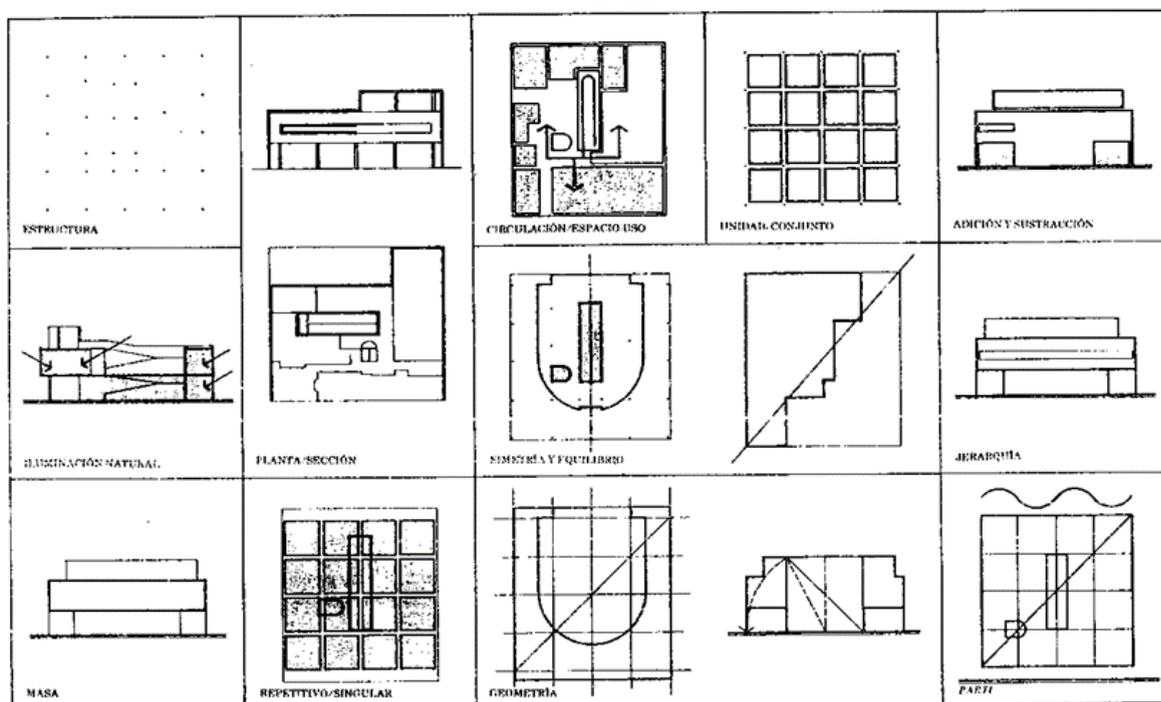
Implantação, cortes, elevações e plantas da Villa Savoye
